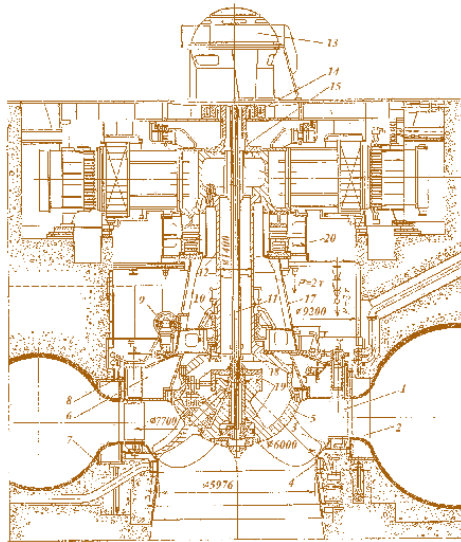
Розріз по гідроагрегаті Зейської ГЕС із діагональною поворотлопатевою турбіною й зонтичним генератором: 1 – лопатки напрямного апарата; 2 – колони статора; 3 – сферична частина камери робочого колеса; 4 – нижній пояс камери робочого колеса; 5 – робоче колесо турбіни; 6 – кришка турбіни; 7 – спіральна камера; 8 – опорний фланець; 9 – сервомотор напрямного апарата; 10 – турбінний підшипник; 11 – мастилопроводи до сервомотора робочого колеса; 12 – вал; 13 – маслоприймач; 14 – генераторний підшипник; 15 – надставка вала; 16 – маточина ротора генератора; 17 – опорний конус; 18 – кришка робочого колеса; 19 – сервомотор робочого колеса; 20 – підп'ятник
